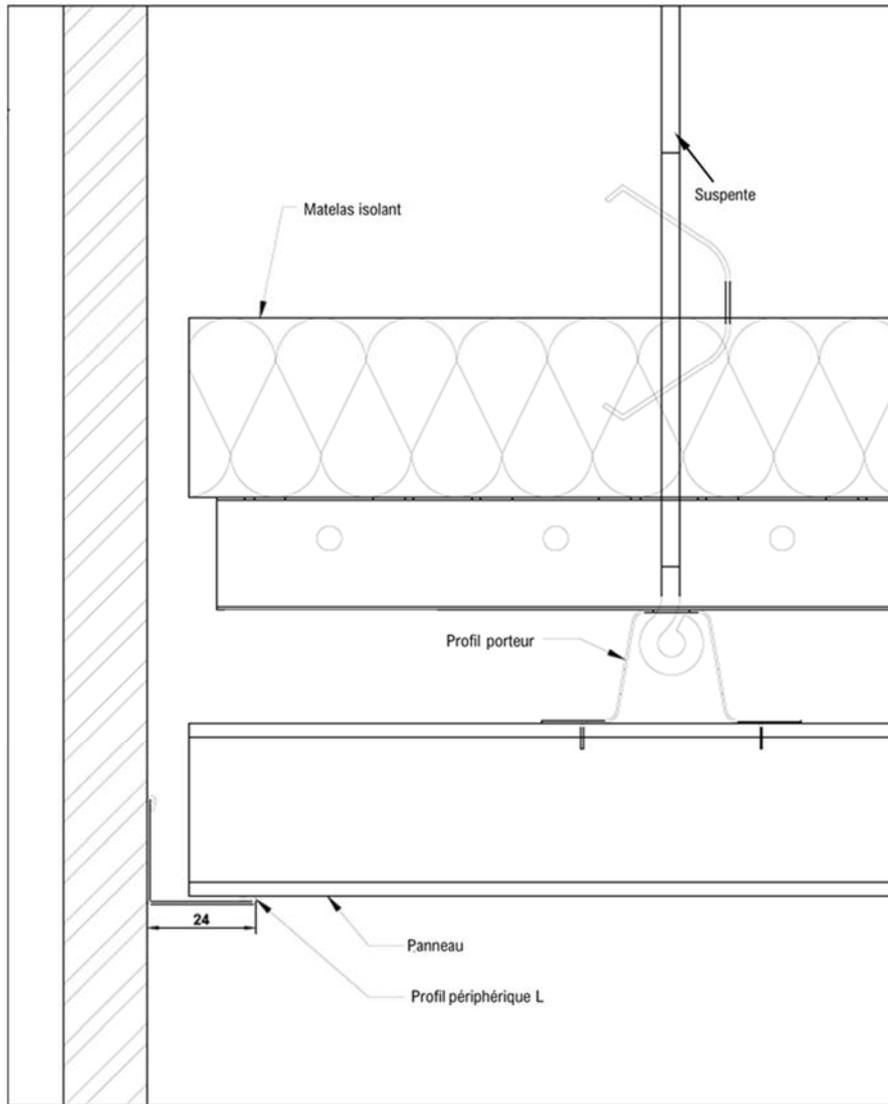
coupe longitudinale du plafond SAPP Ceiling®
